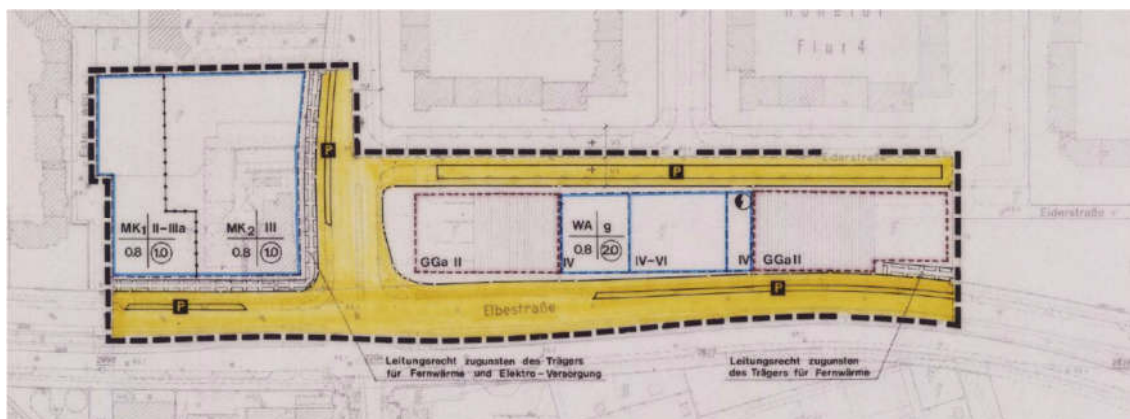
Auszug aus der Planzeichnung des Bauungsplans HO29
